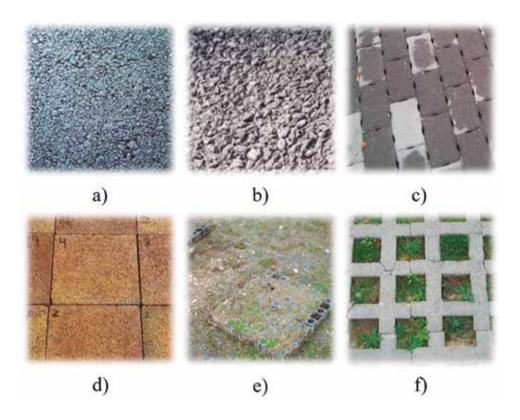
Tipos de superficie en pavimentos permeables a) Asfalto poroso b) Hormigón poroso c) Adoquines impermeables con juntas abiertas d) Adoquines de hormigón poroso e) Césped reforzado con celdas de plástico f) Césped reforzado con celdas de hormigón
